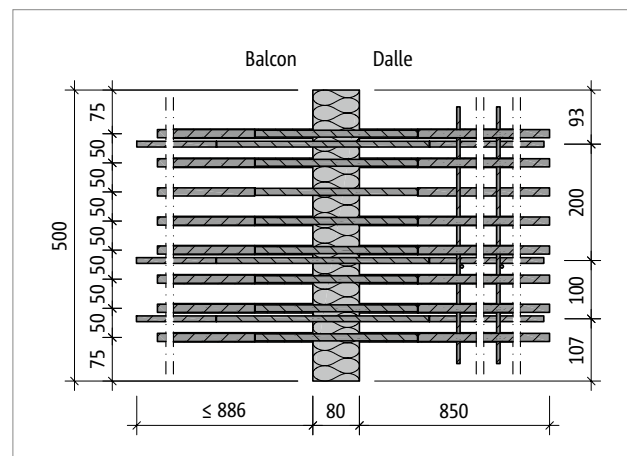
Schöck Isokorb® T Type K-M14-V3 : Plan de base du produit
